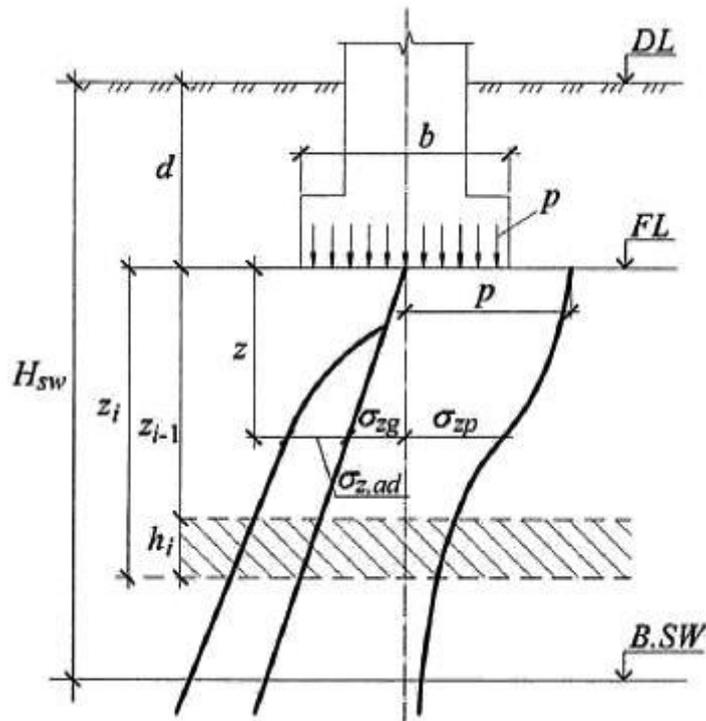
Схема к расчету подъема основания при набухании грунта
